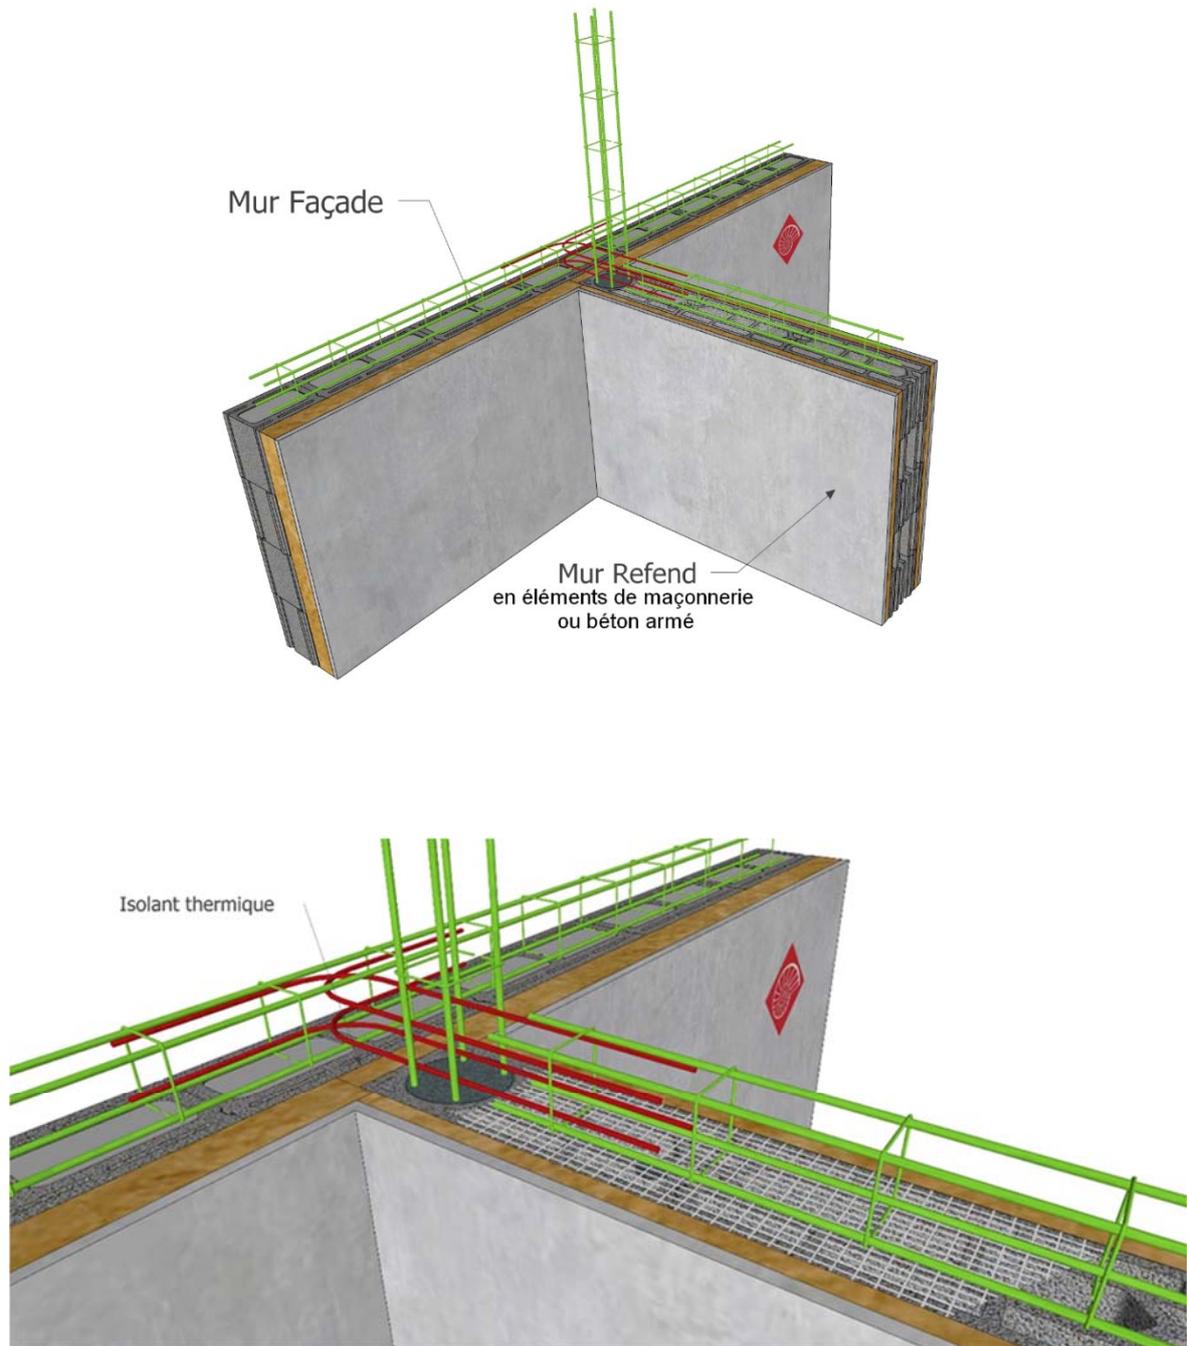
Jonction par juxtaposition d'un mur de refend à un mur de façade en zone sismique
